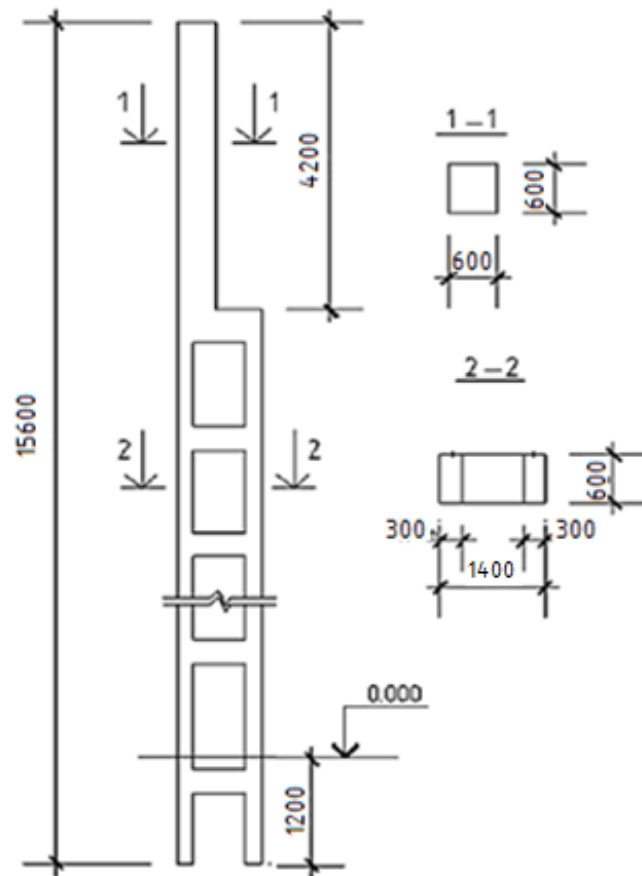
Залізобетонна колона крайніх рядів
